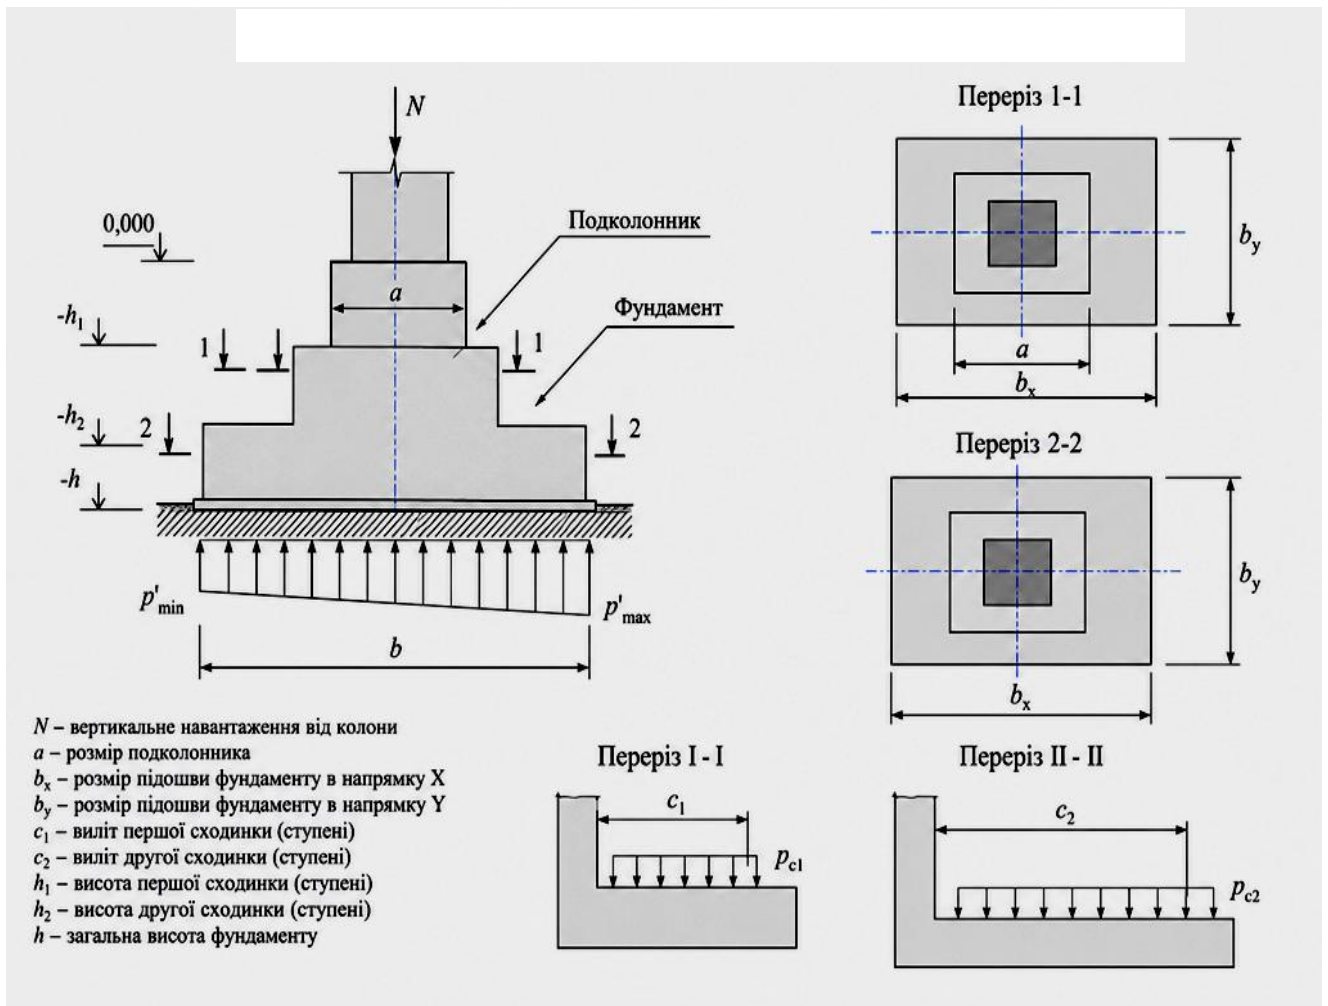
Схема розрахункових перерізів окремо стоячого фундаменту
